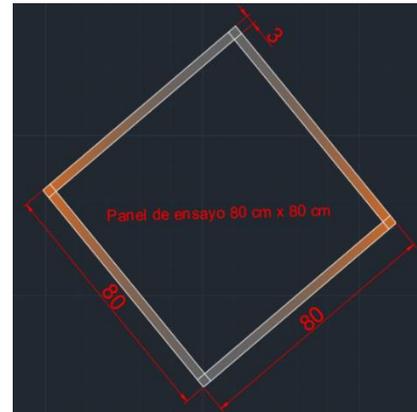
Dimensiones del panel de ensayo a la compresión diagonal.
